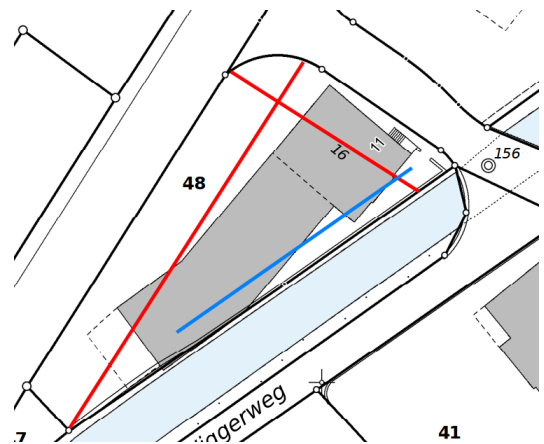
Skizze Abstandslinien (rot: 6 m ab Kantonsstrasse, 5 m ab Gemeindestrasse / blau: 3 m ab Gewässerrand)
